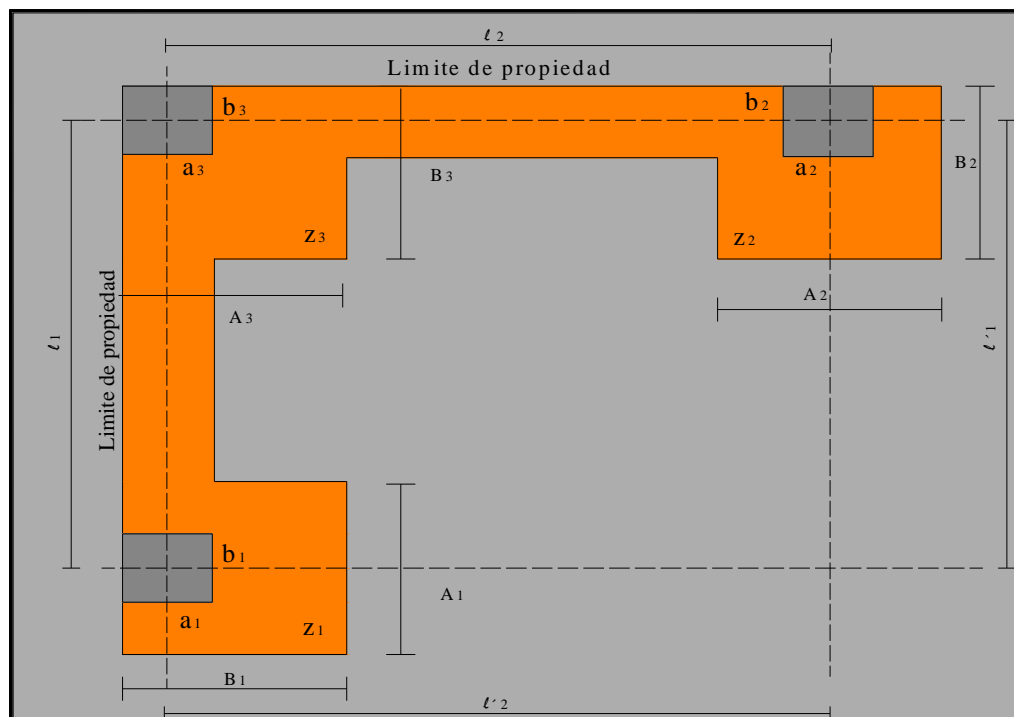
Zapata de esquina conectada (Vista en planta)
